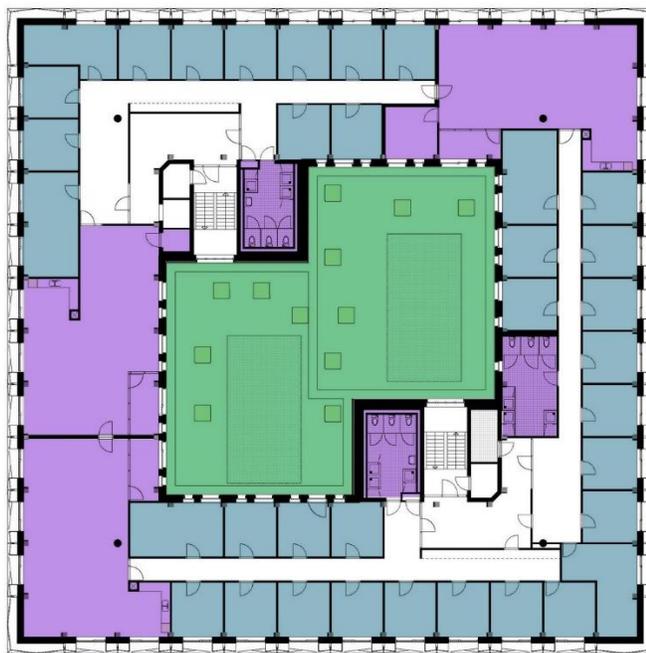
PLANTA DO PAVIMENTO TÉRREO
